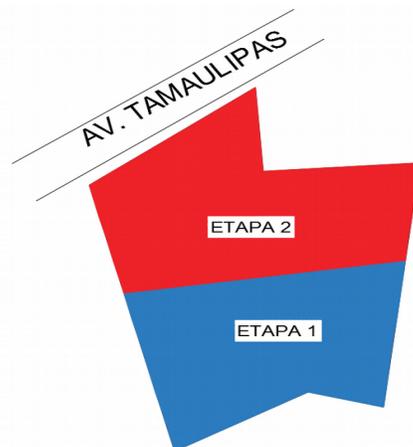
ETAPAS DE EXCAVACIÓN
